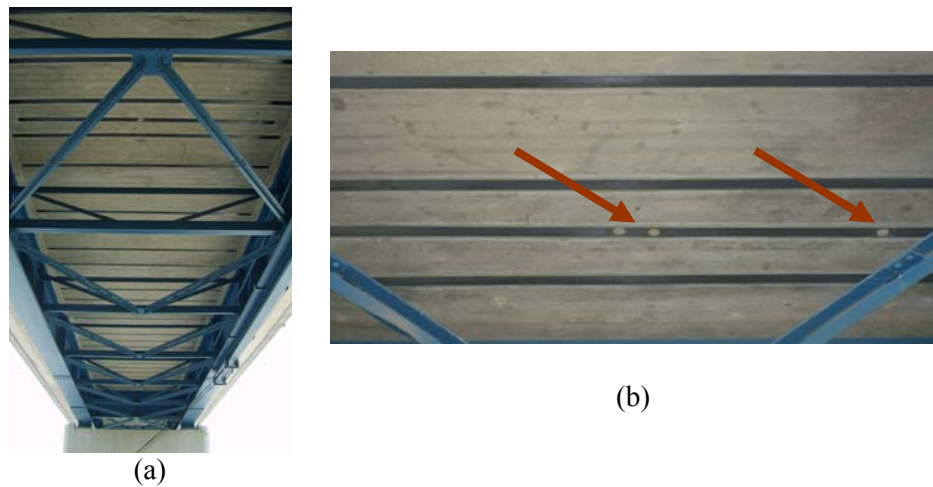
Teste de arrancamento realizado em uma ponte de concreto armado reforçada com laminados de PRFC: (a) Vista do deck da ponte; (b) Detalhe dos pontos em que foram realizados os testes de arrancamento.
